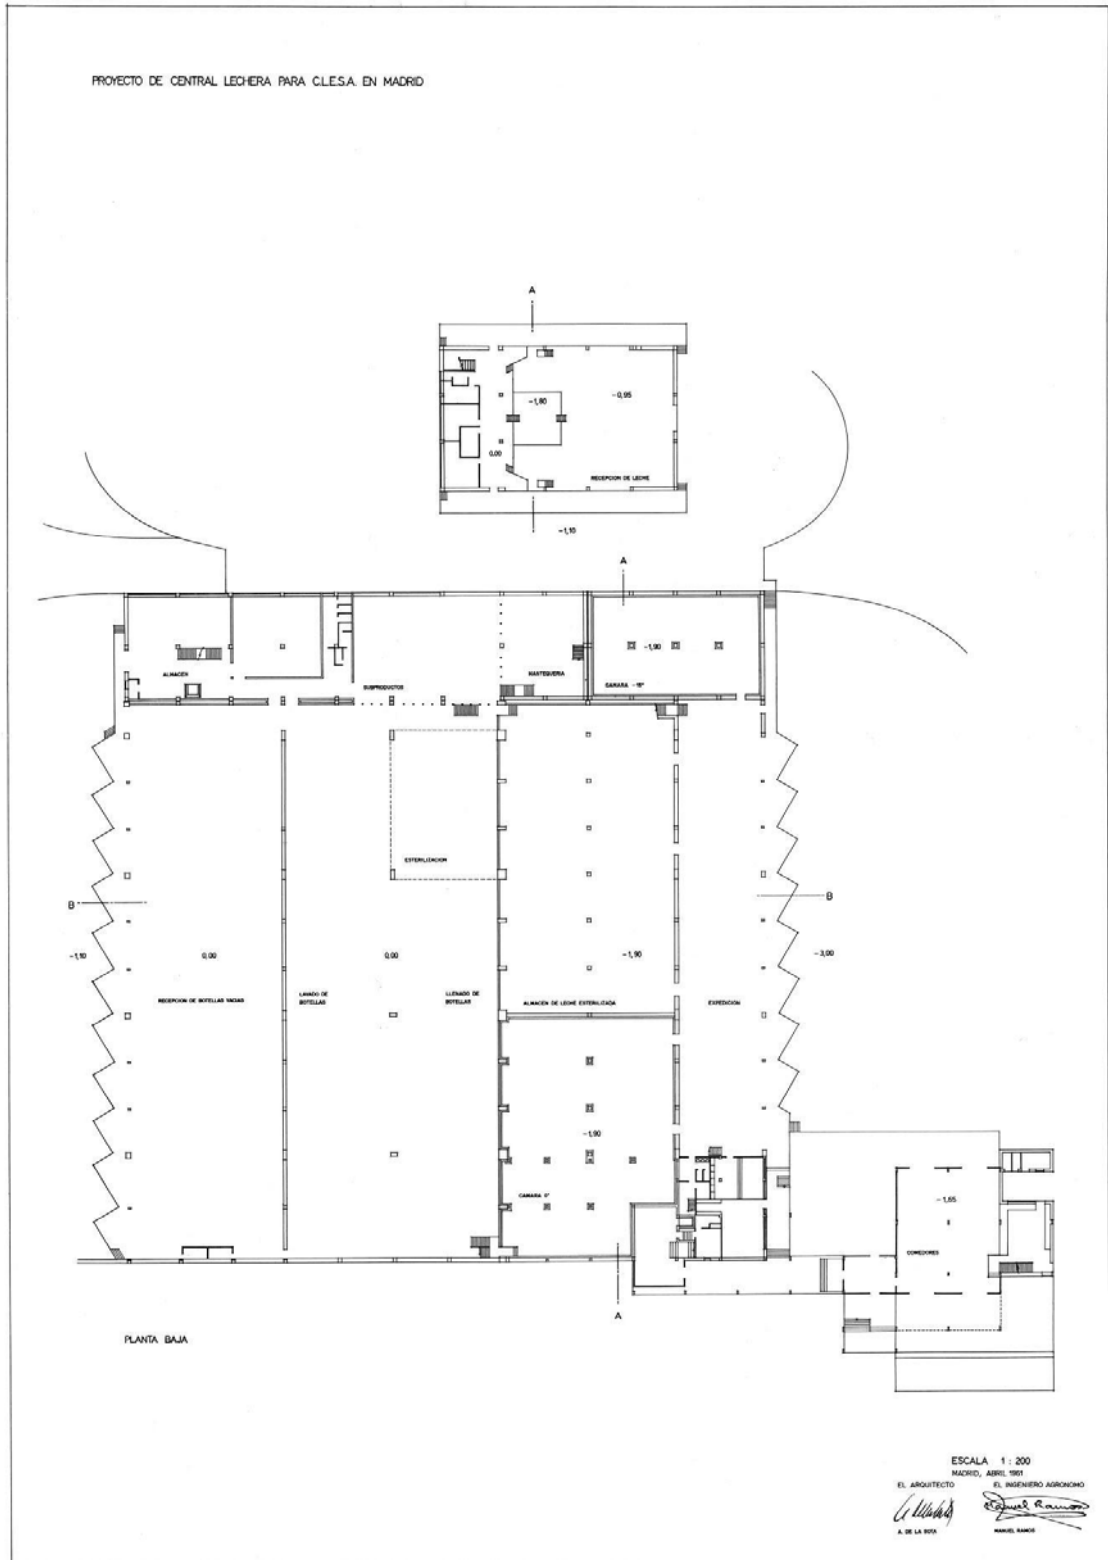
Planta baja. Proyecto de 1958. COAM. Norte hacia abajo.
